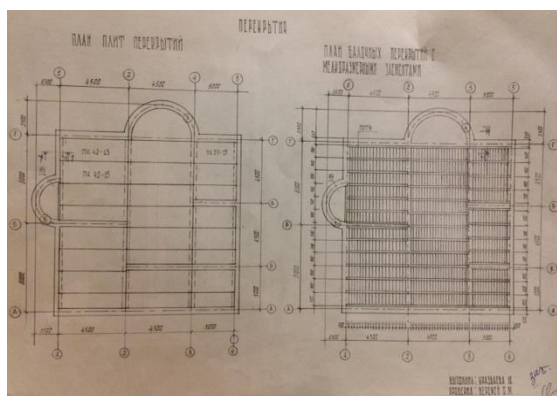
Разработка плана перекрытия из железобетонных плит и балочного перекрытия с мелкоразмерными элементами (студенческая работа)
